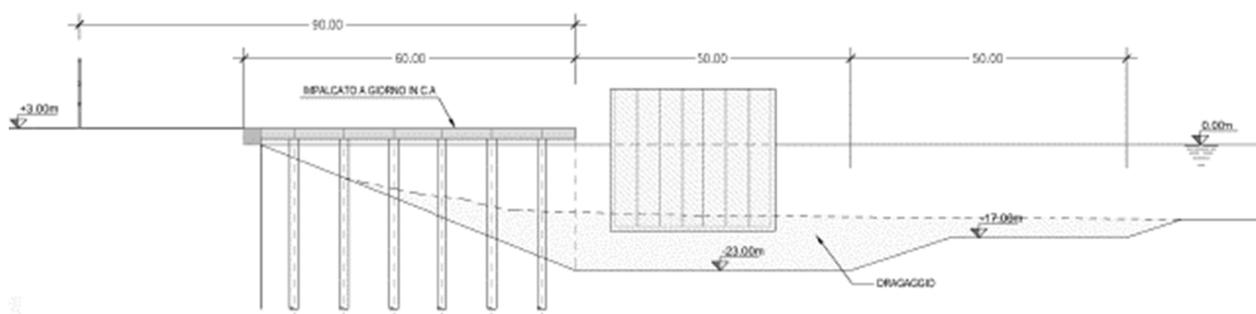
AREA DI CANTIERE DI PRÀ-VOLTRI. SEZIONE TRASVERSALE
